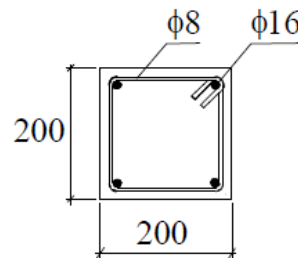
Detalle del armado de la viga, cotas en mm. (Claeson 1999)
